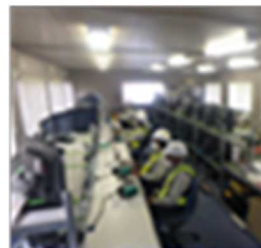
無線による遠隔操作状況 図-7 自動化施工のイメージ
